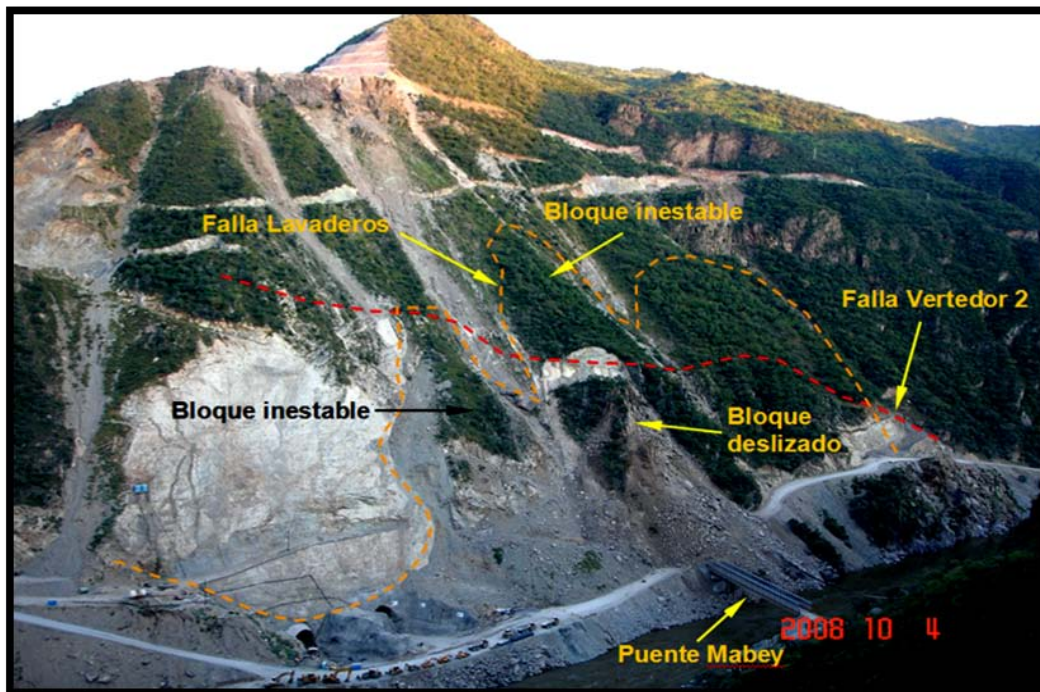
Vista del deslizamiento en la margen izquierda, bloques inestables sobre la falla Lavaderos (Marengo, 2008).
